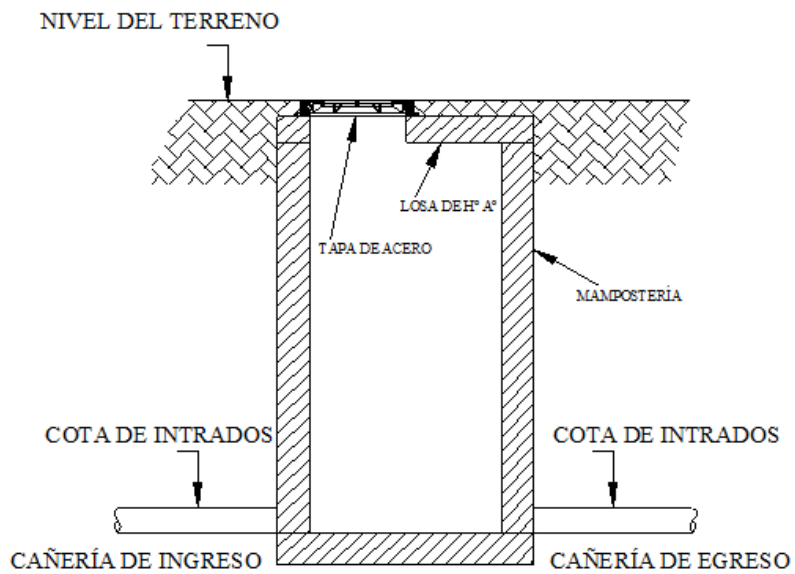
Corte boca de registro para cañerías a gravedad
